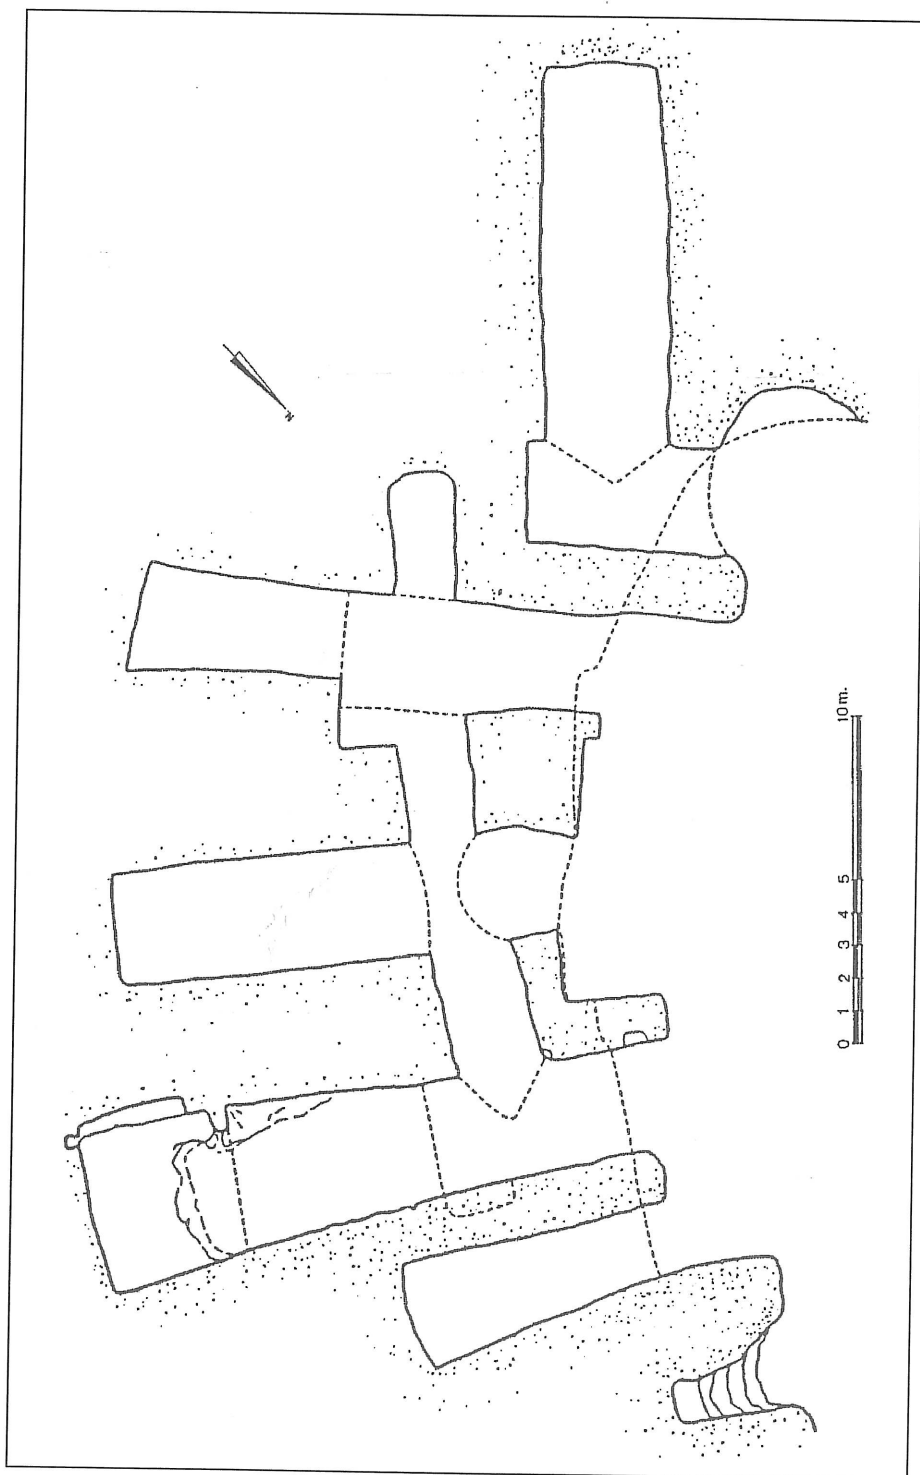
Iglesia rupestre de Coin (Málaga). Planta (según: Puentes Tricas)
